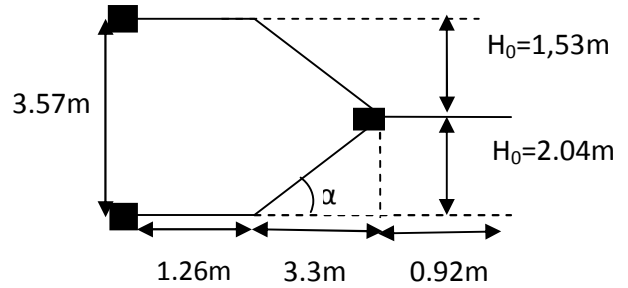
Coupe A-A 1 d'escaliers du 1er étage
